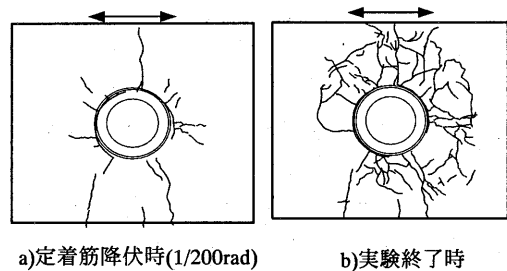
パイルキャップのひび割れ状況例(No.1)
